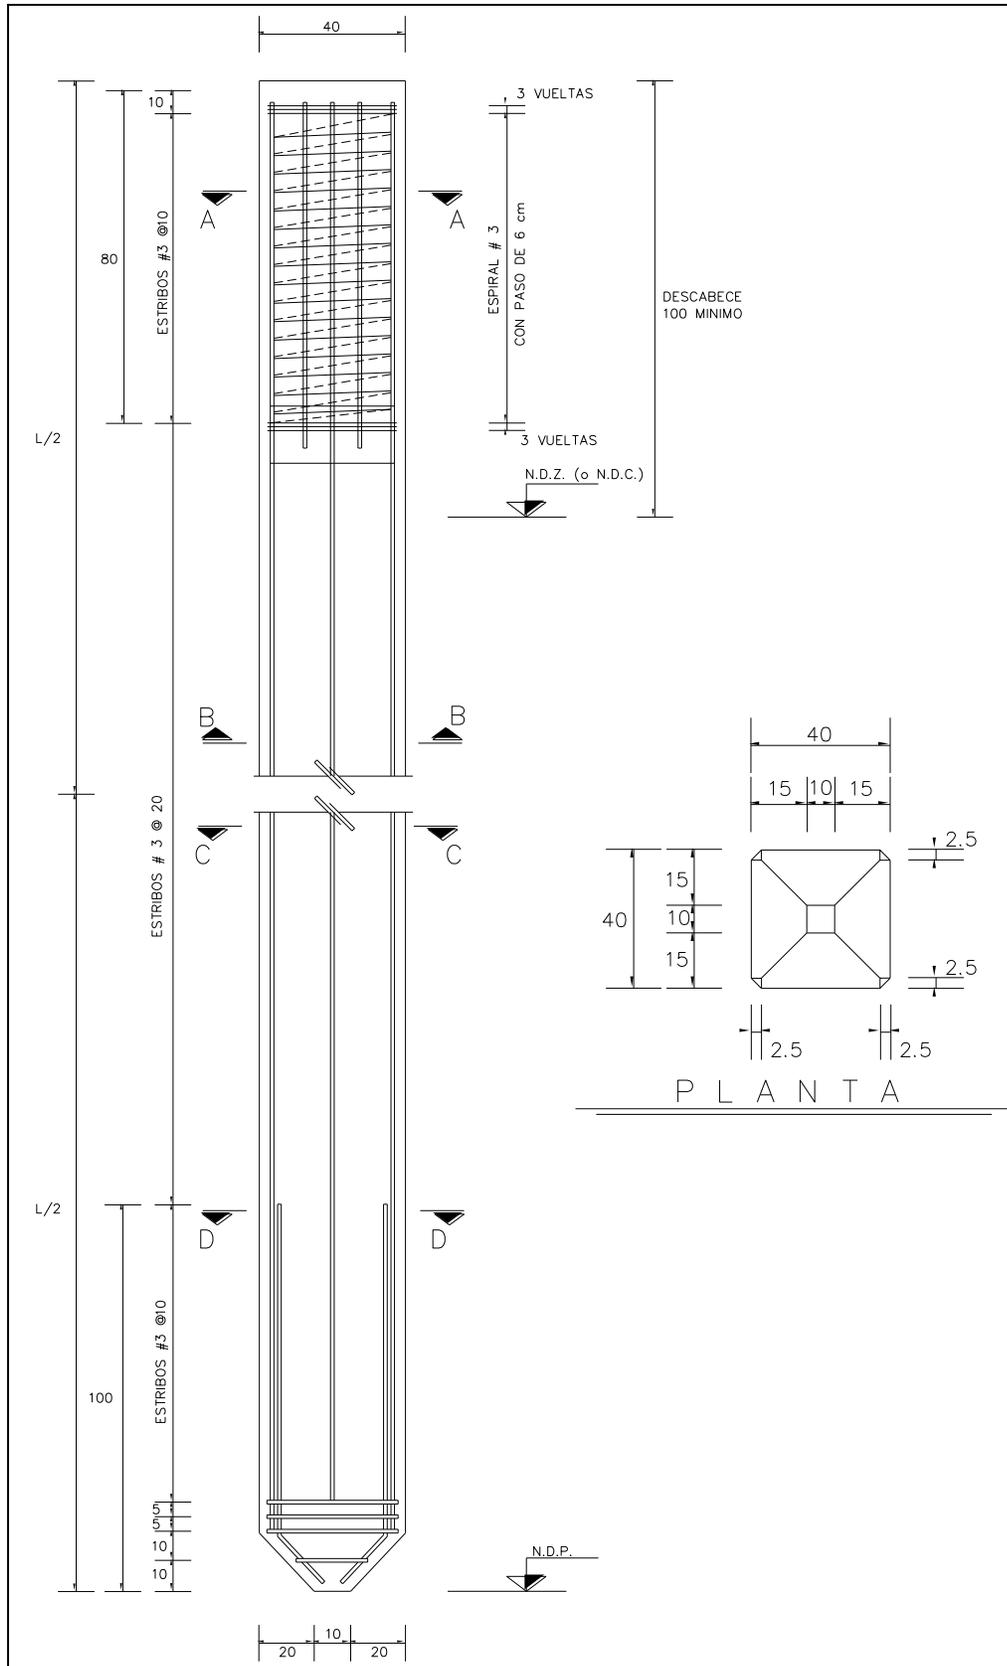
Sección del pilote de 40 X 40 cm y planta
